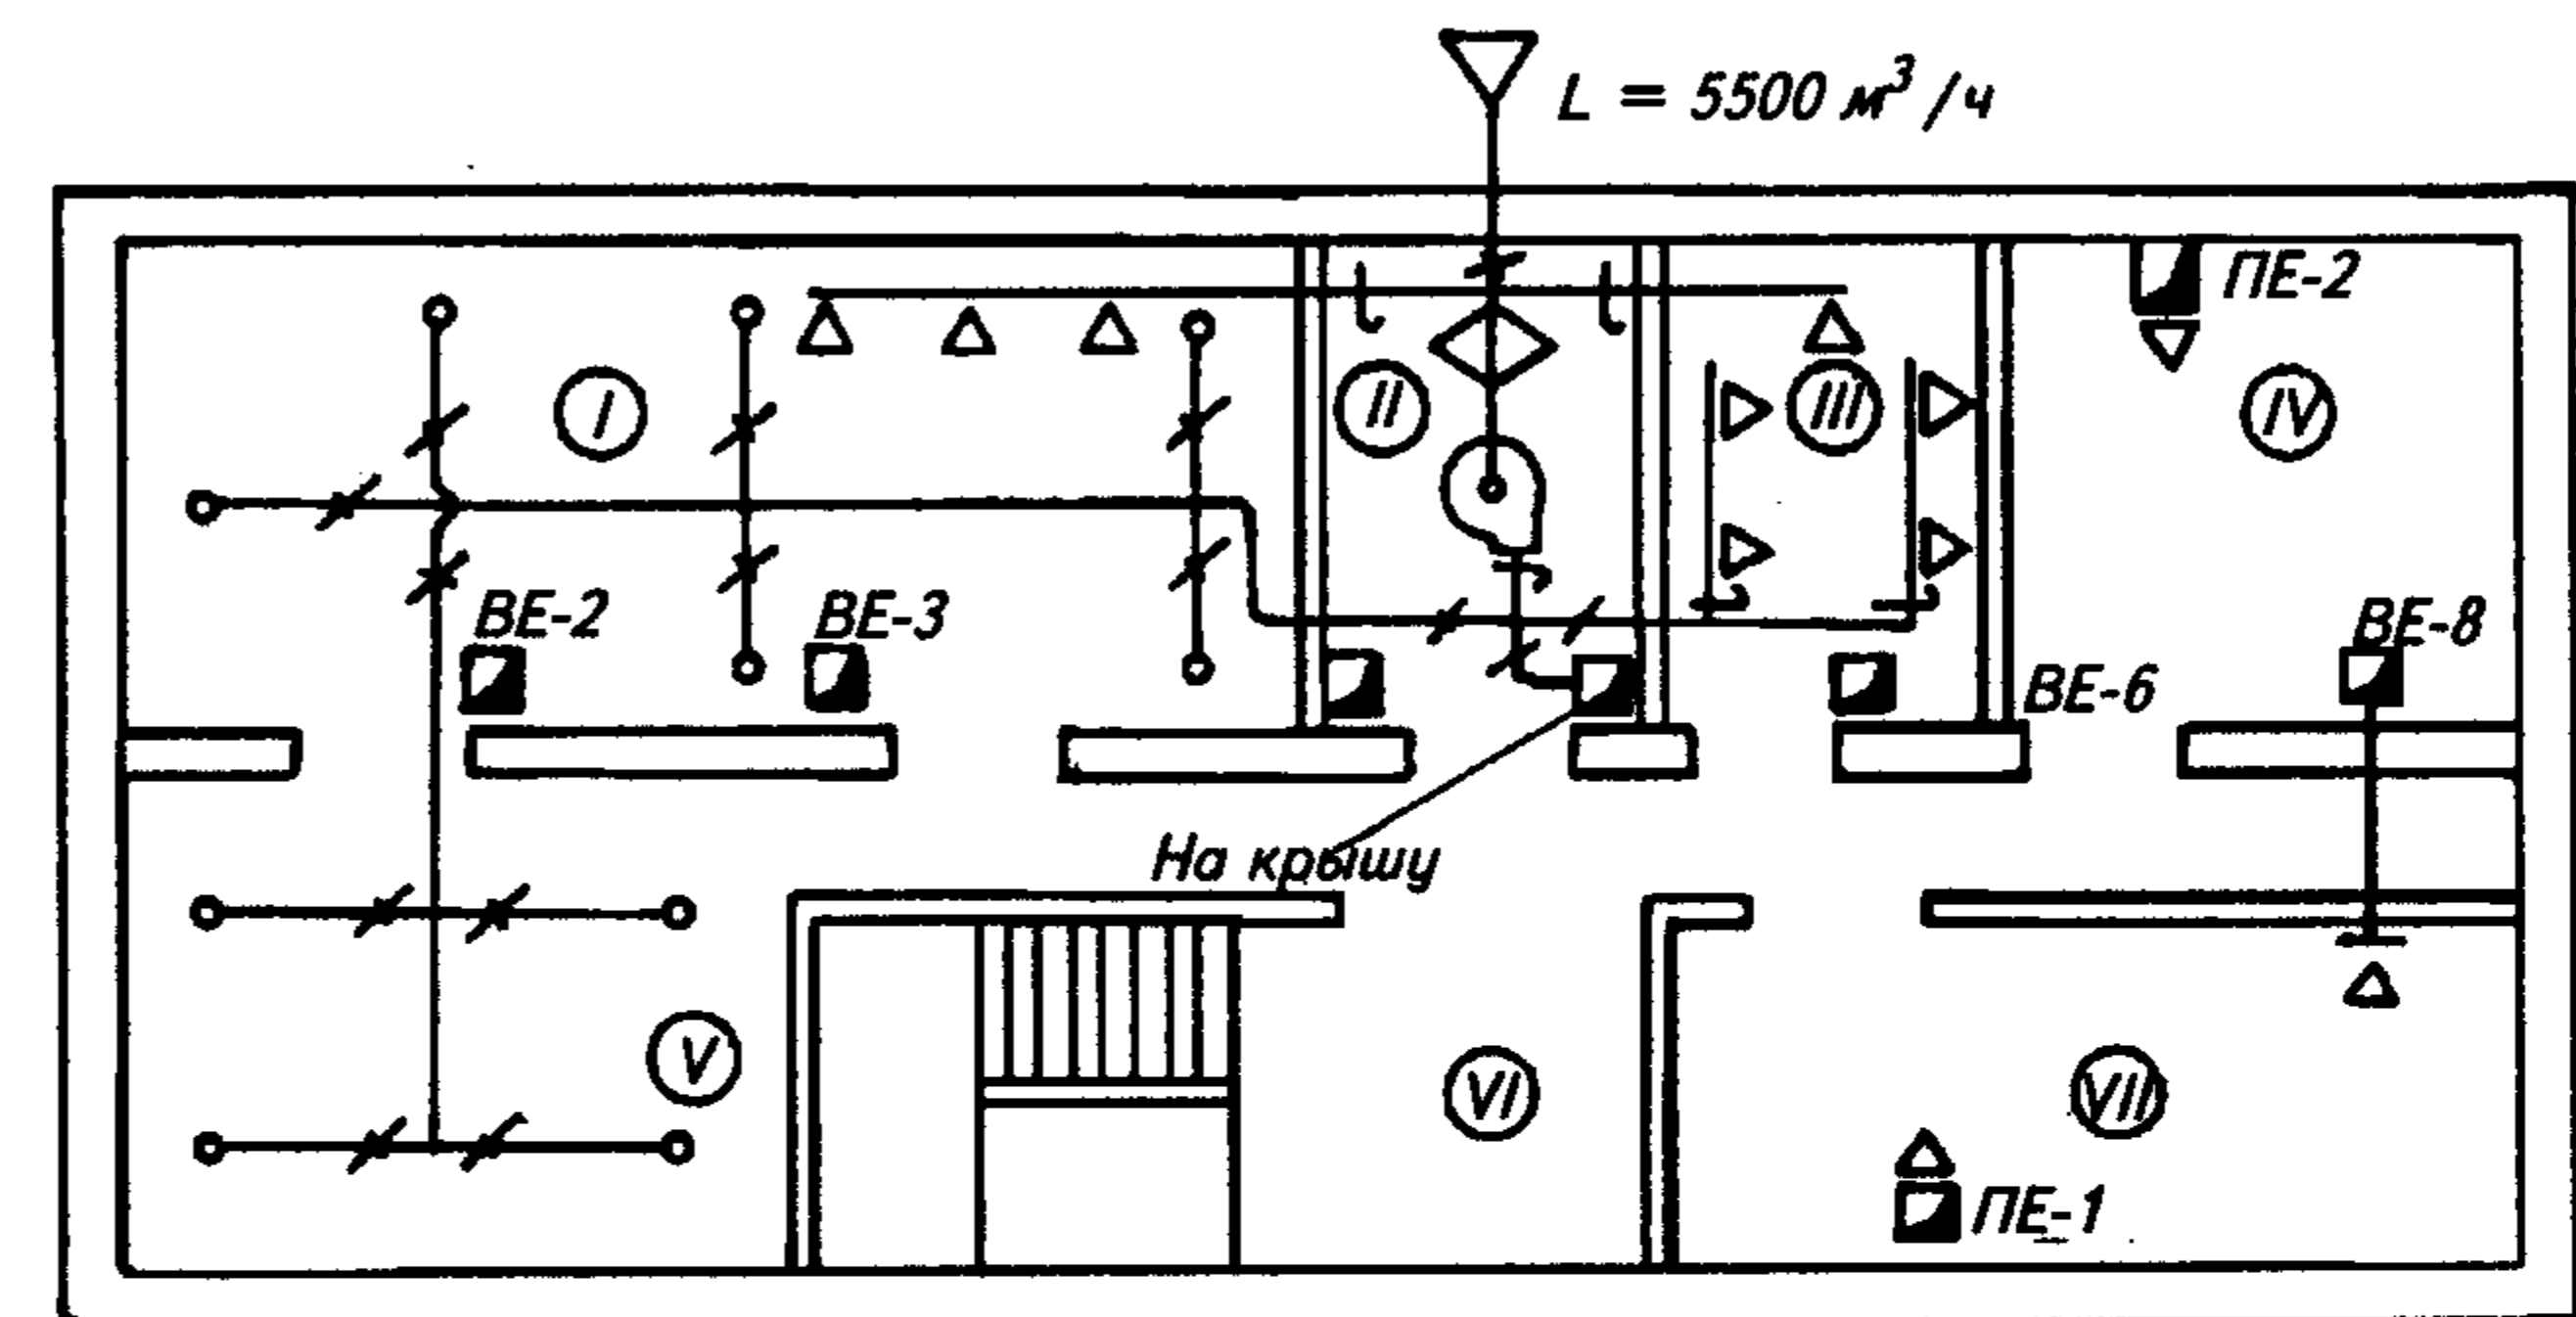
Принципиальная схема вентиляции хранилищ картофеля и овощей. Помещения:
